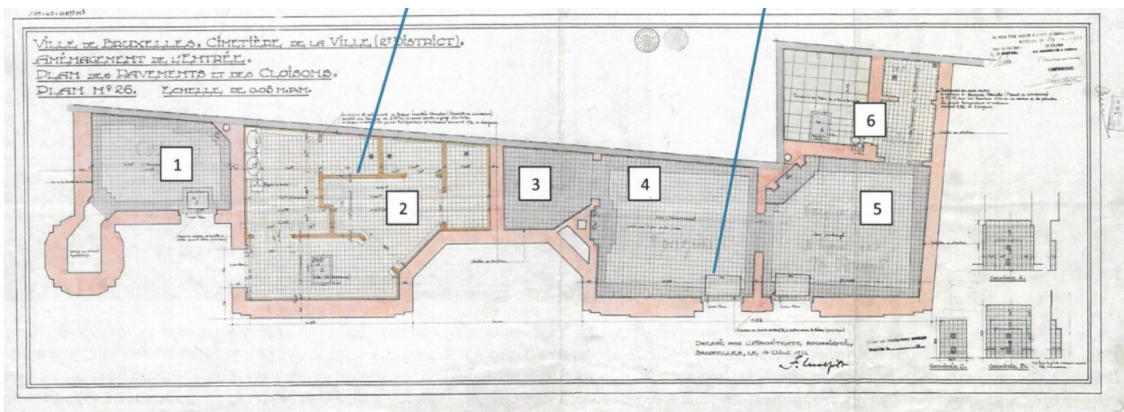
Plan du lobby d'accueil du cimetière de Laeken, signé par F. Malfait le 13 août 1932. AVB Fonds NPP G2.
